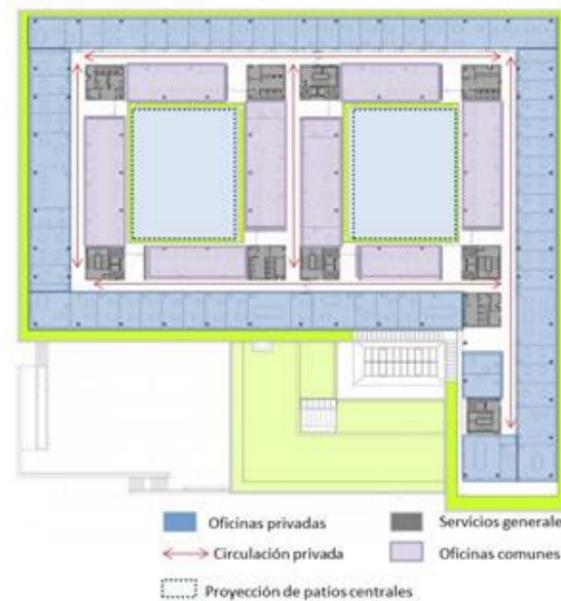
Edificio Administrativo - Zonificación: Planta tipo
